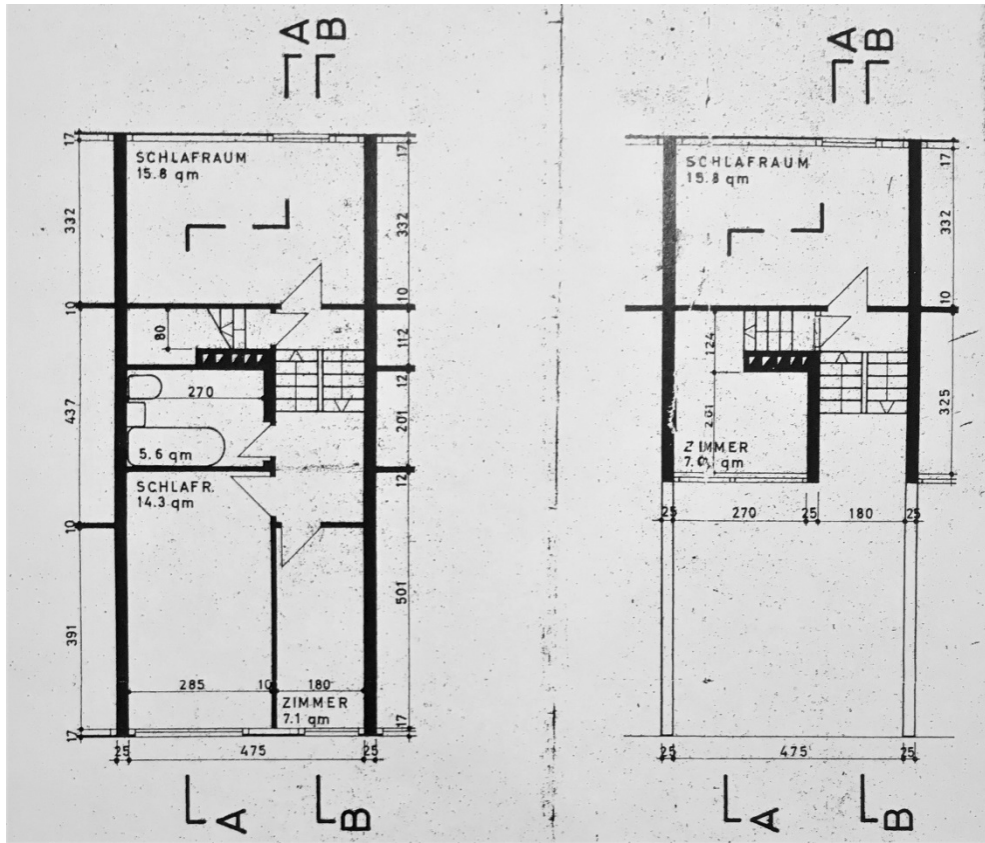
Siedlung Krautberg: Grundrisse 1. Stock und 2. Stock (v.l.n.r.), 1967
